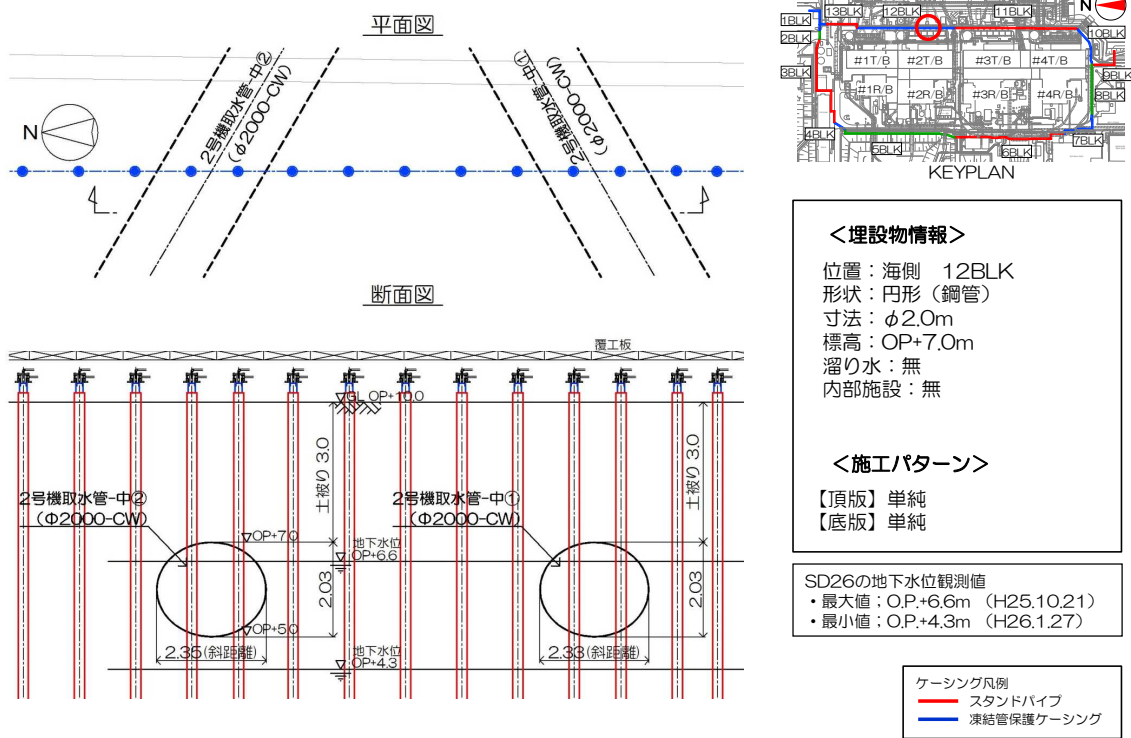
【12-2】2号機取水管-中①② 施工方法（貫通施工）
